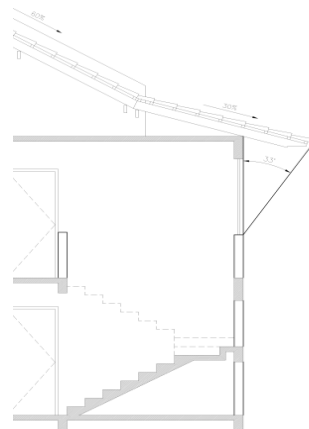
Projeto 4 - Corte – ângulo de proteção do elemento horizontal na fachada norte.
